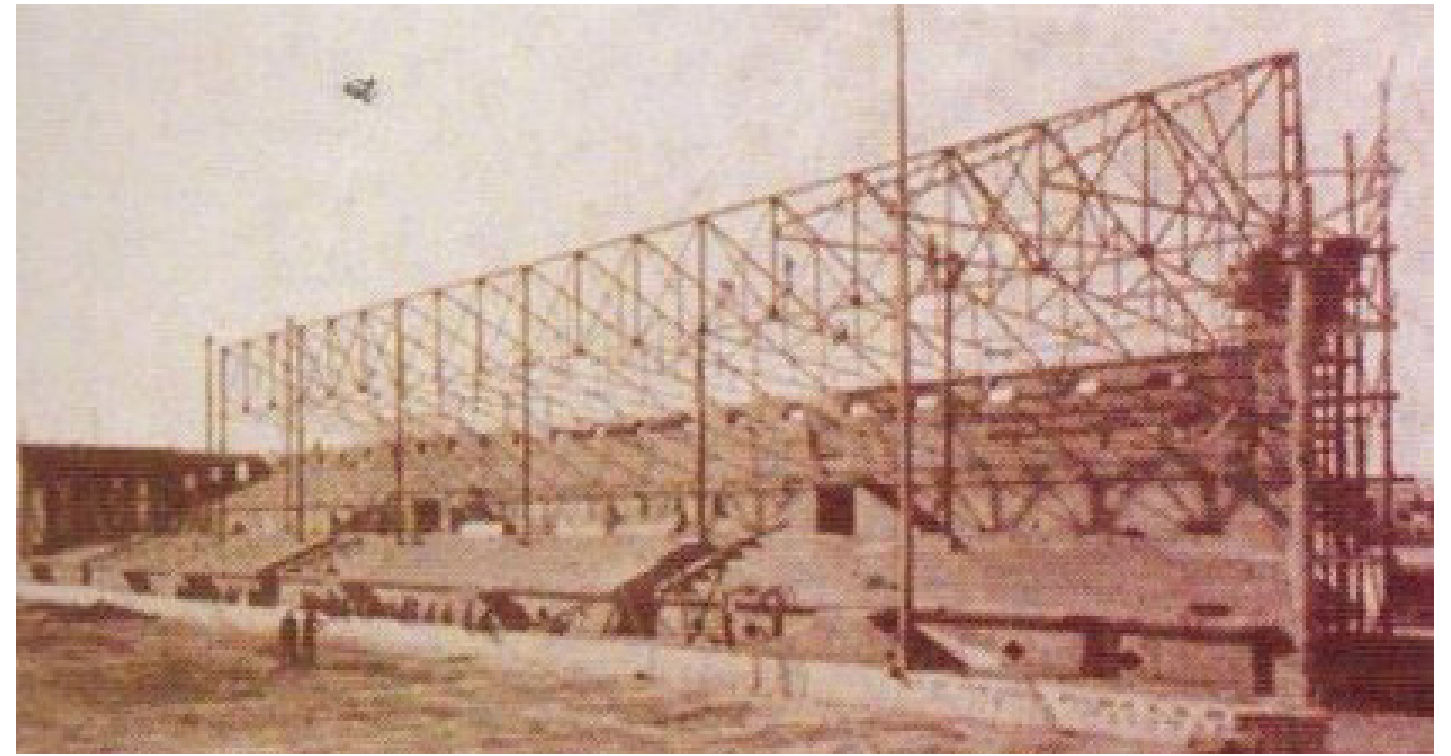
Fotografías de la cubierta de la tribuna en construcción.
